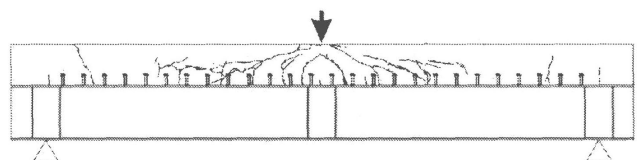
正曲げ試験体のひび割れ状況 (加力終了時, CASE3)
